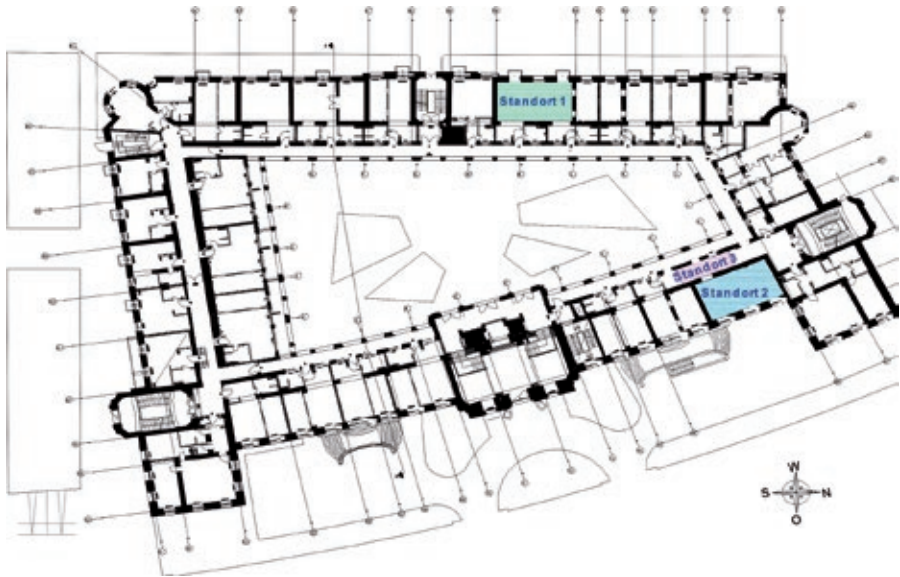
Grundriss des zukünftigen Wohngebäudes mit Standortauswahl für Belastungsversuche
